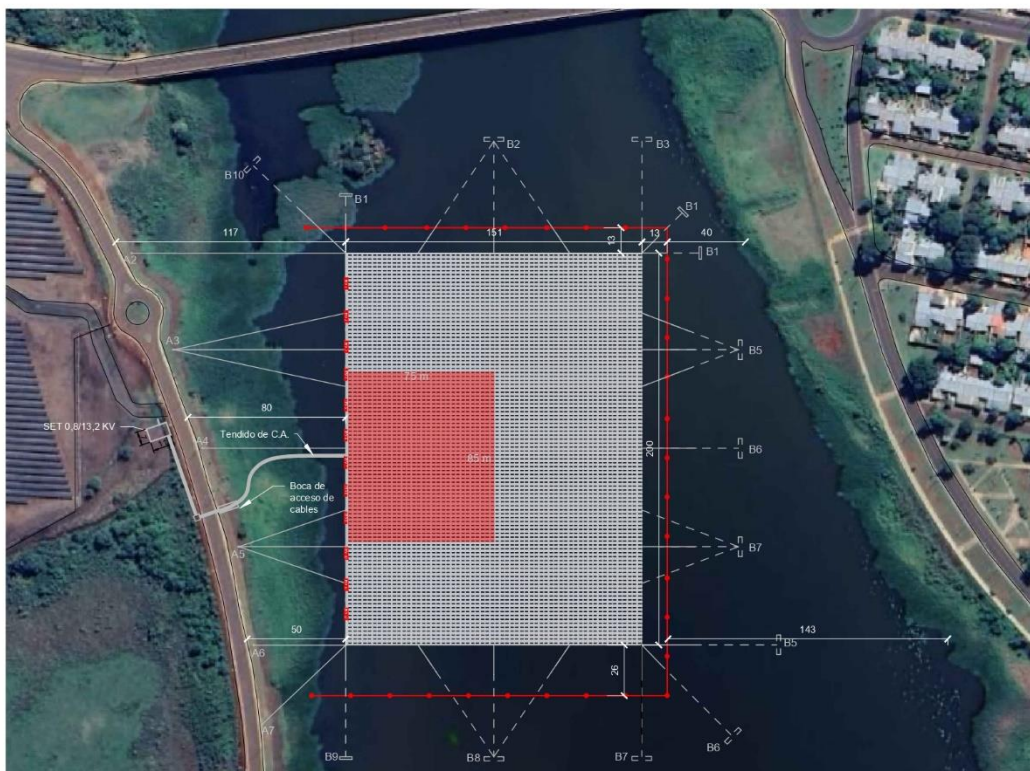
Layout de parque solar fotovoltaico primer etapa.
